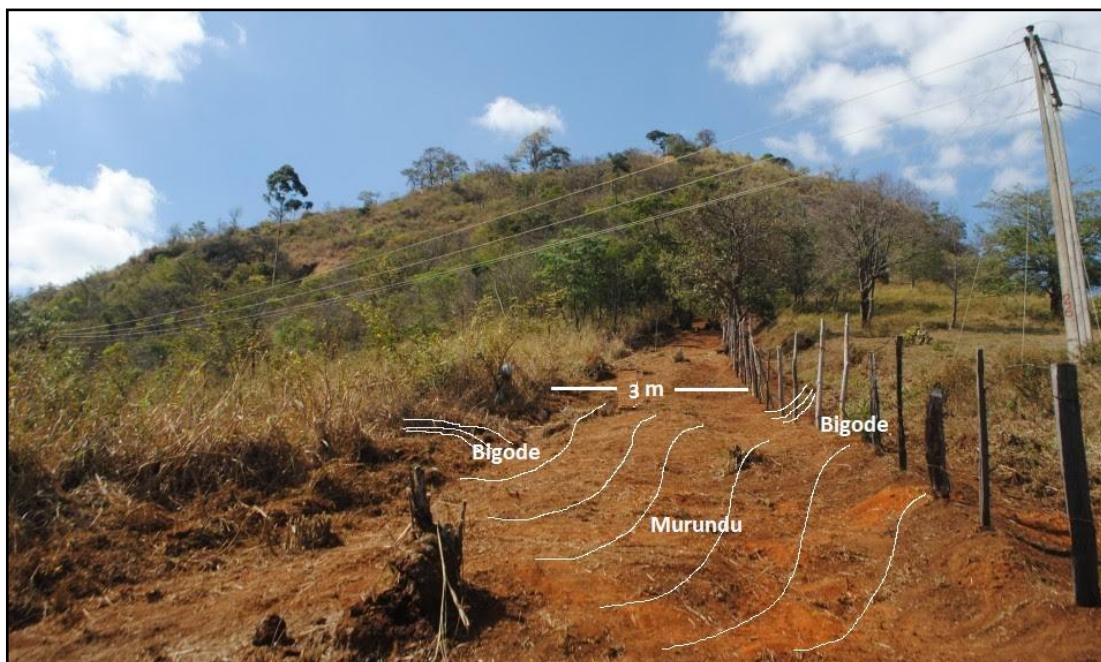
Indicação de estruturas de controle da erosão e condução de saída d'água em aceiro
